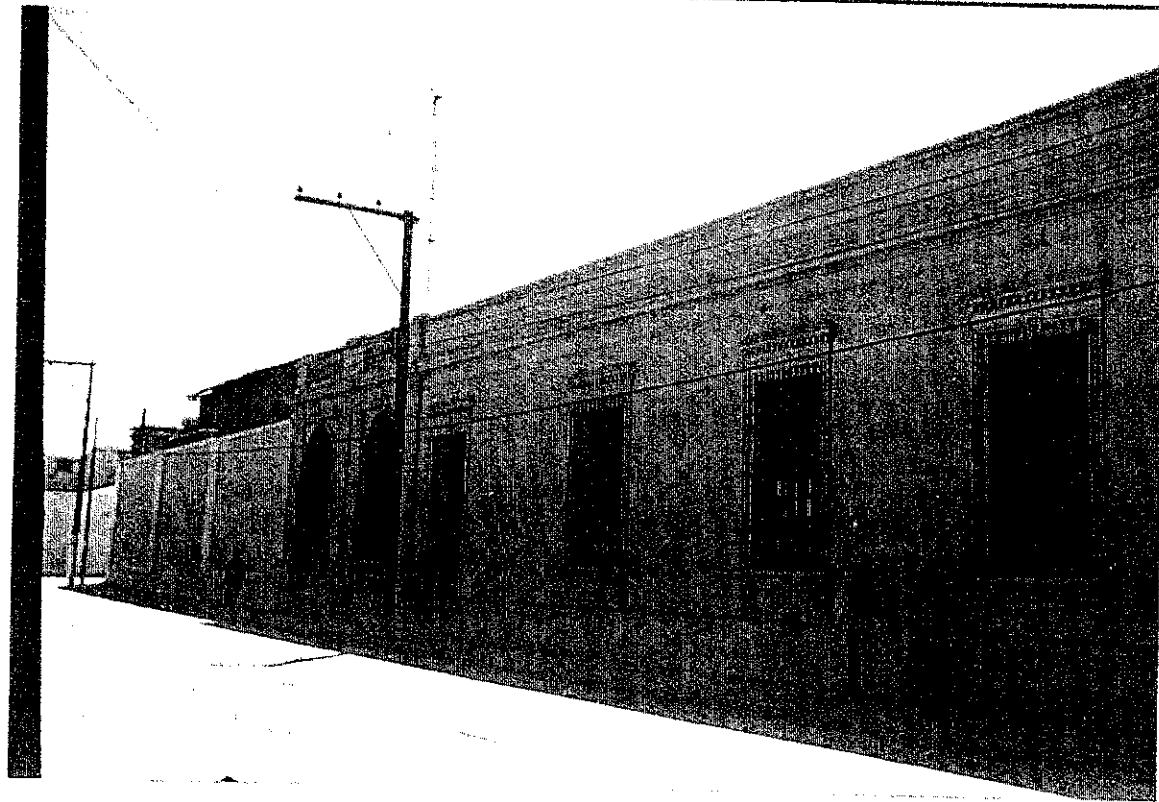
Vista de la fachada de La 10 Avenida entre 14 y 14 Calle "A" se observan manchas en las paredes.
